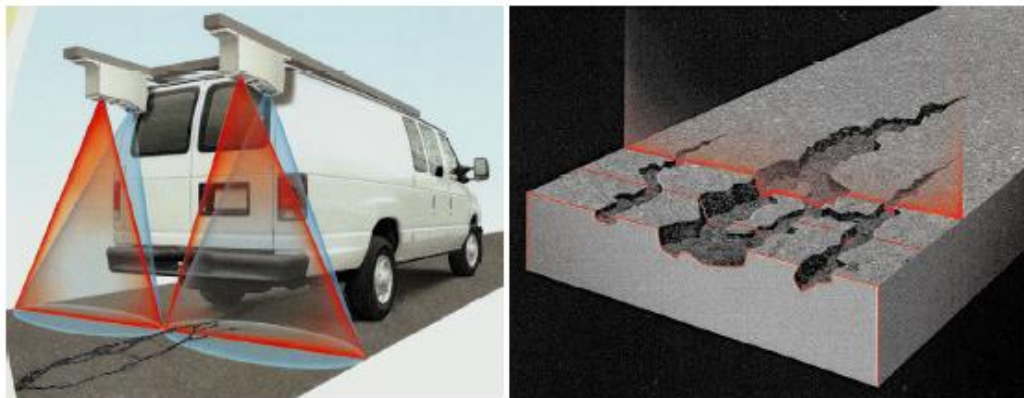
Esquema de funcionamiento de los equipos de auscultación superficial de pavimentos tipo Video-láser. Recuperado de <http://www.pavemetrics.com/applications/road-inspection/lcms2-en/>
